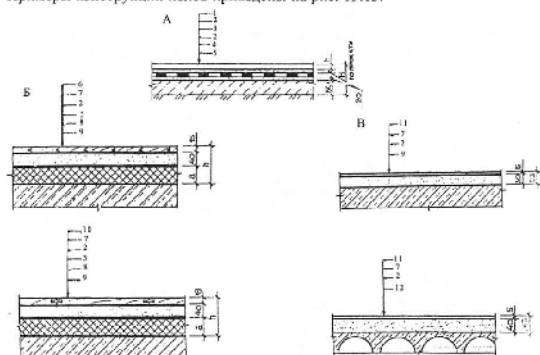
Схемы конструкций полов: А - наливные; Б - штучные; В - рулонные; 1 - асфальт; 2 - цементно - песчаная стяжка; 3 - гидроизоляция; 4 - подстилающий слой бетона; 5 - грунт основания с керамзитованным щебнем или гравием крупностью 40 - 60 мм; 6 - паркет штучный; 7 - мастика клеящая; 8 - звукоизоляционный слой; 9 - панель междуэтажного перекрытия; 10 - штит паркетный однослойный; 11 - линолеум на теплозвукоизоляционной подоснове; 12 - панель перекрытия пустотная
